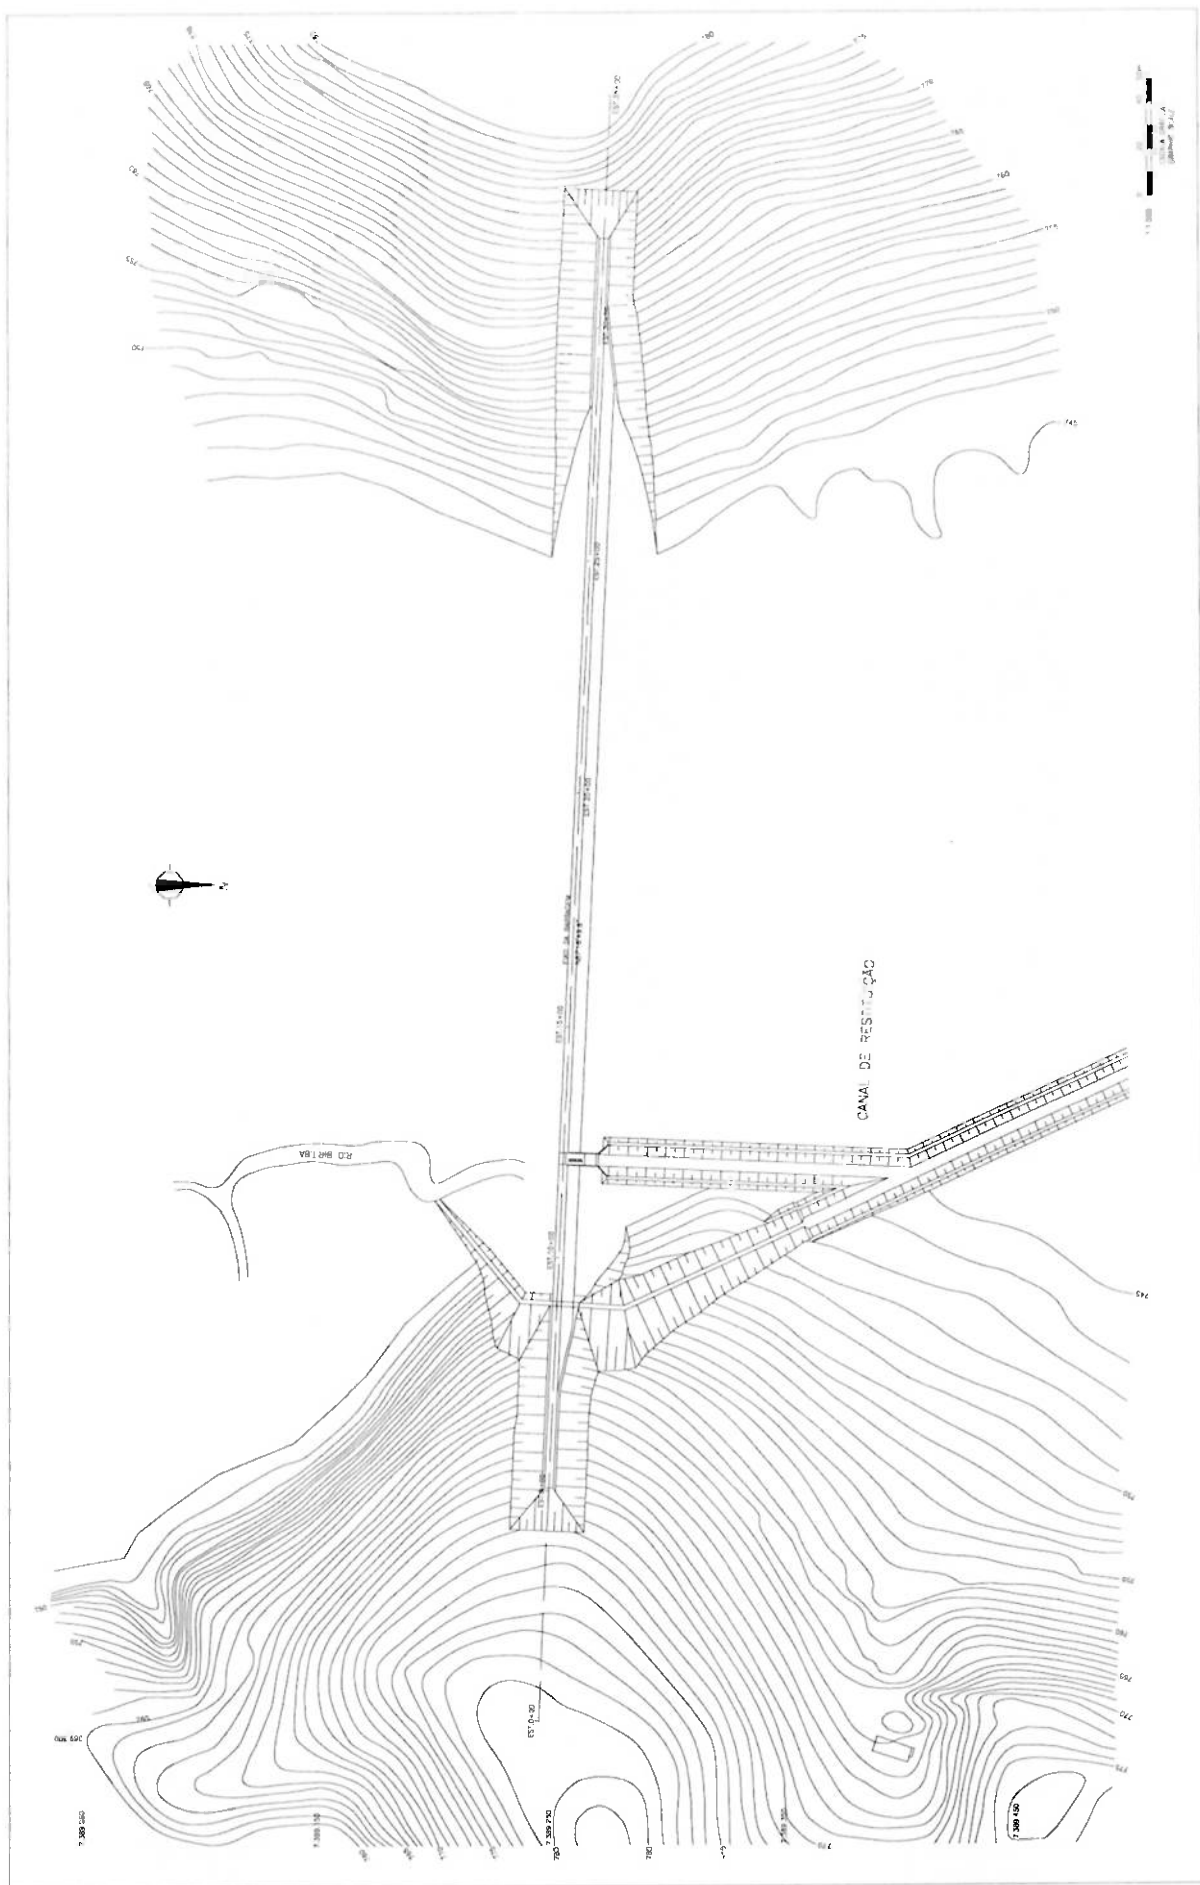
Configuração final da barragem e Canal de restituição
